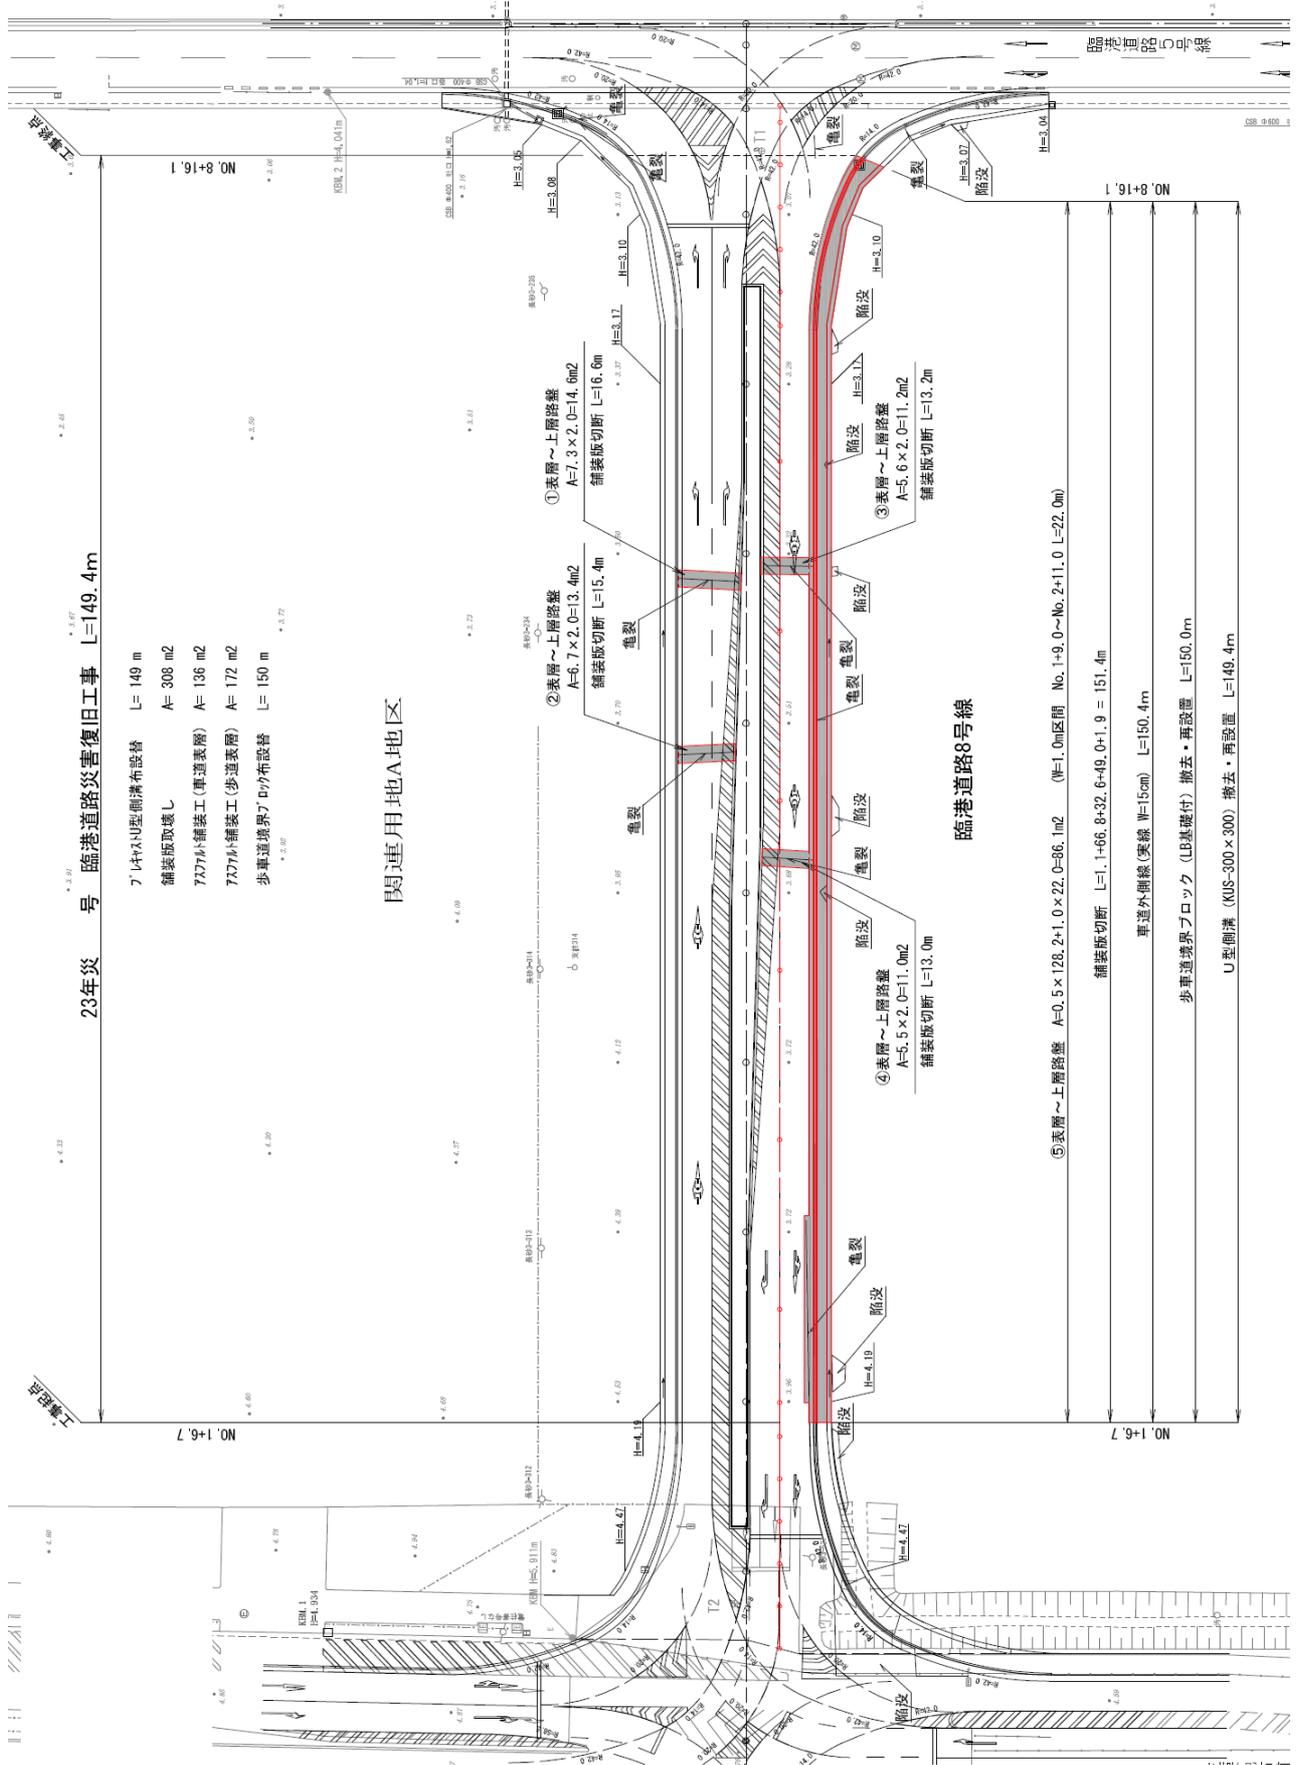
No.10 常陸那珂港区_臨港道路8号線の平面図(復旧後)
